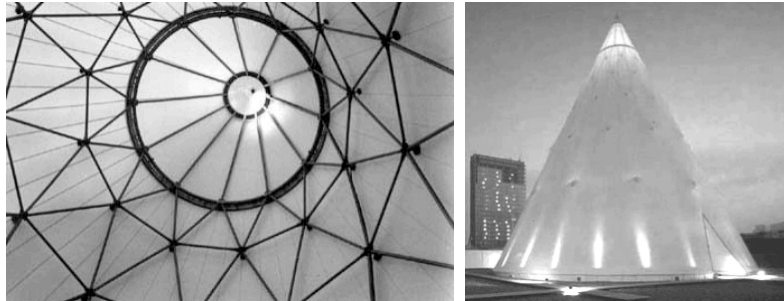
Cet exemple de tipi illustre le concept de toile tendue sur une structure rigide. A gauche, une vue sur la structure du haut du tipi.
